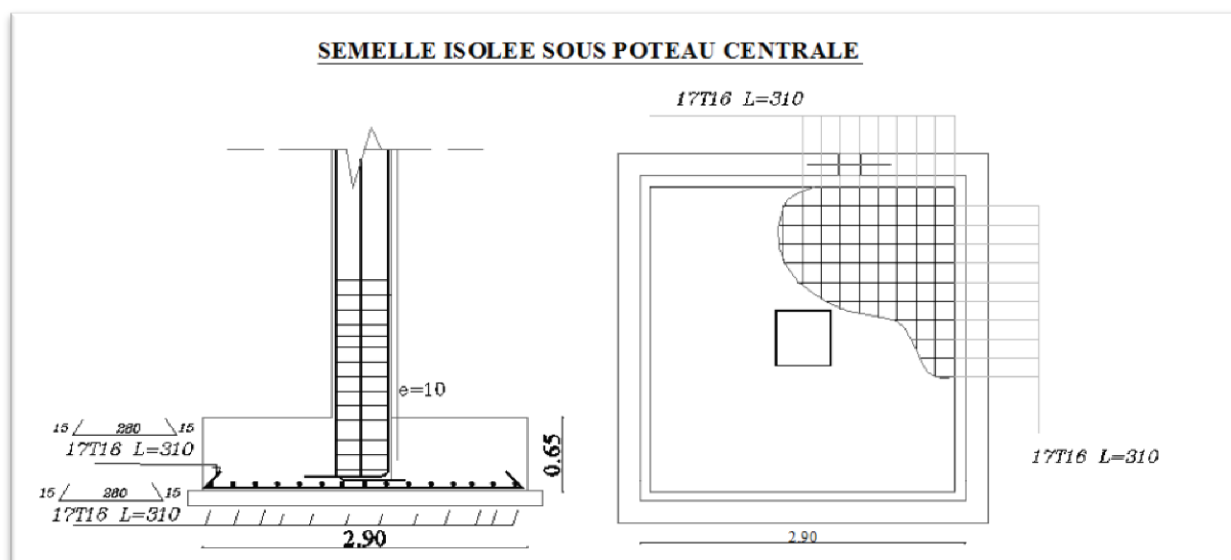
Schéma de ferrailage de semelle isolée intermédiaire (y-y).
